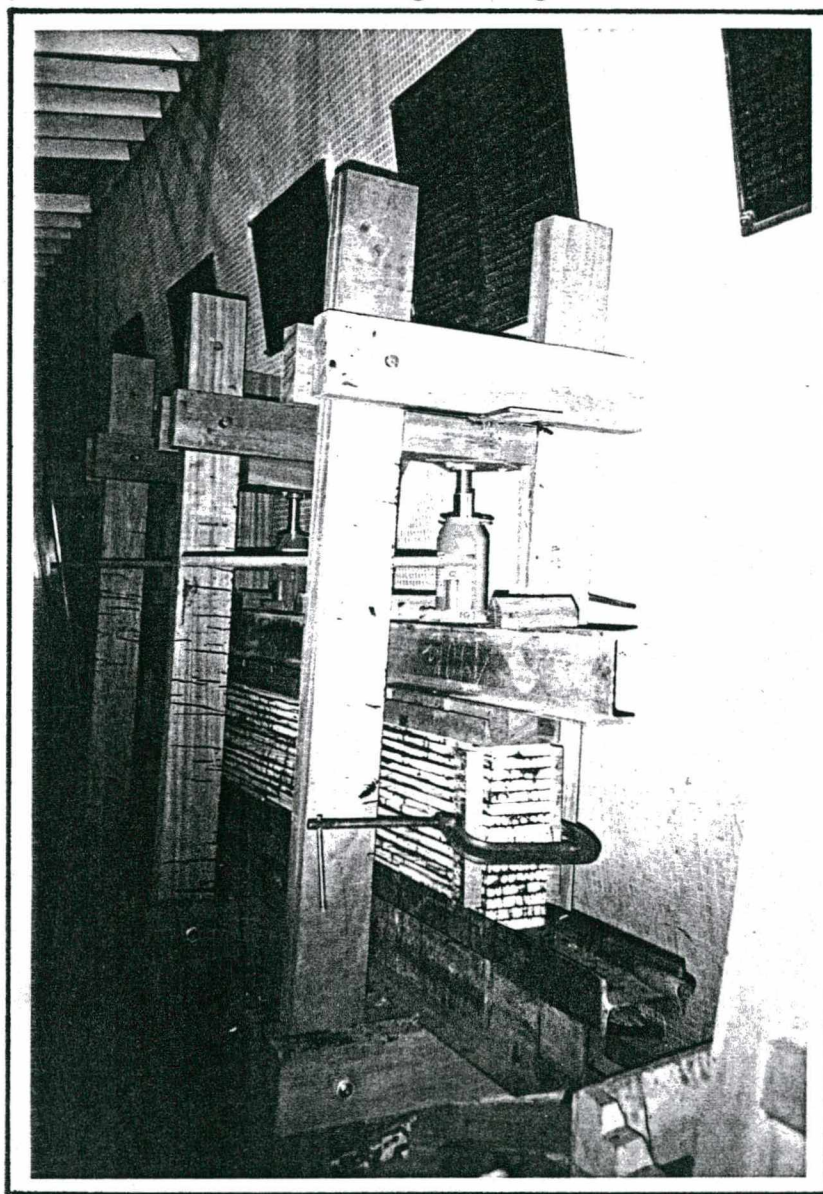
Dispositivo desenvolvido para aplicação de pressão nas vigas
